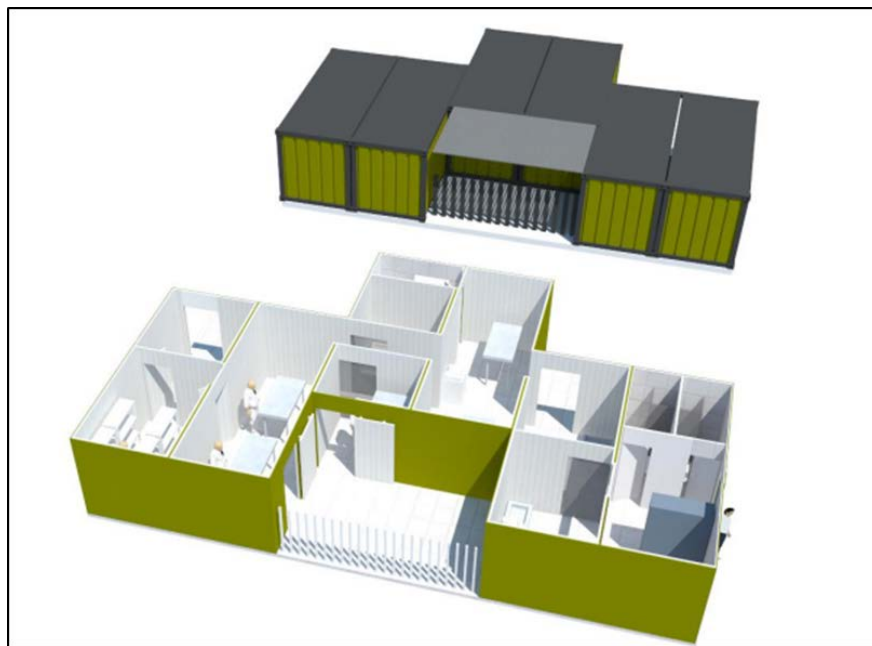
Diseño arquitectónico planta de proceso deshidratado
